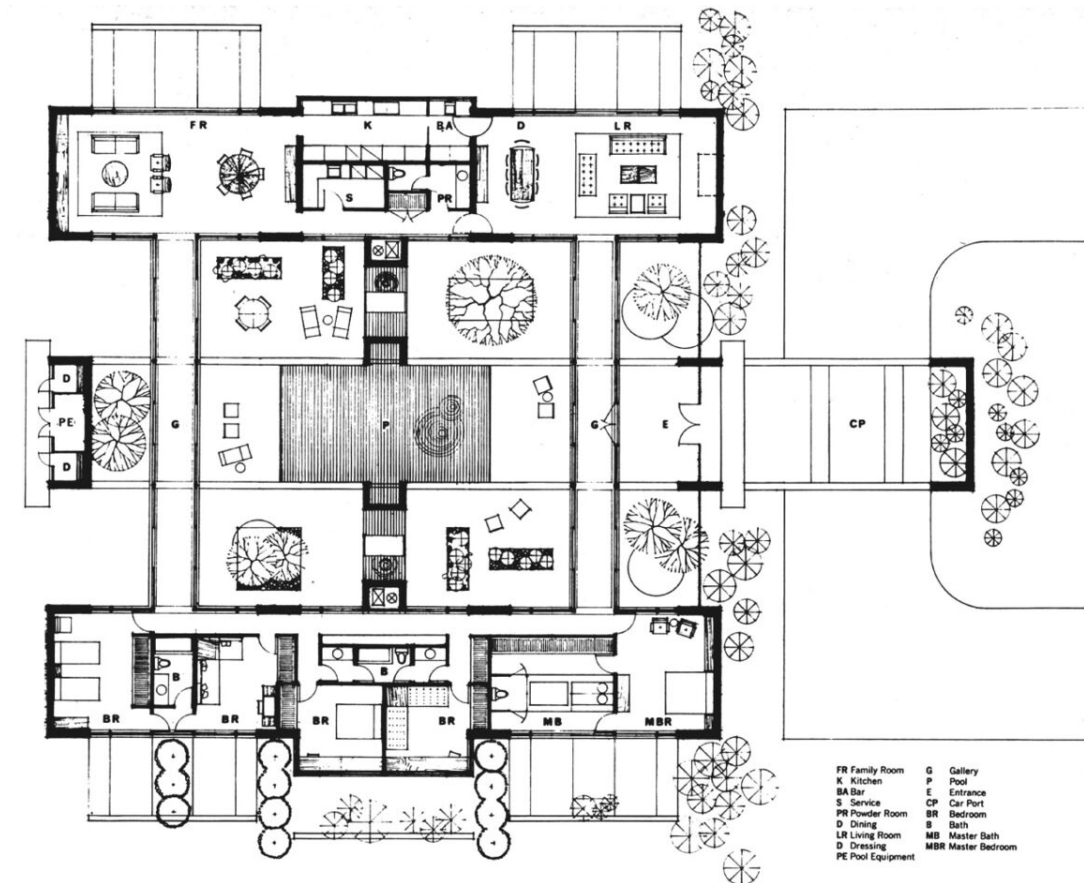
Case Study House n.º 28, Conrad Buff y Donald Hensman (1964-1966). Planta de la vivienda.
